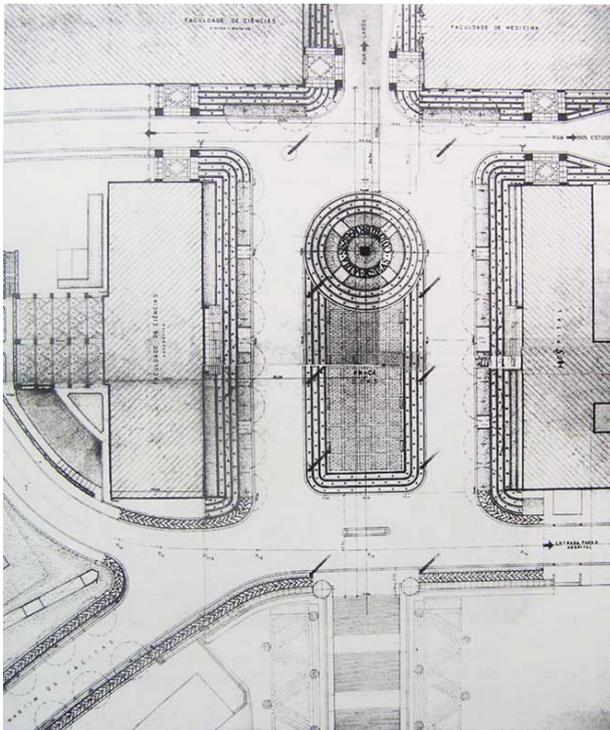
Planta de pavimentação da Praça D. Dinis.
